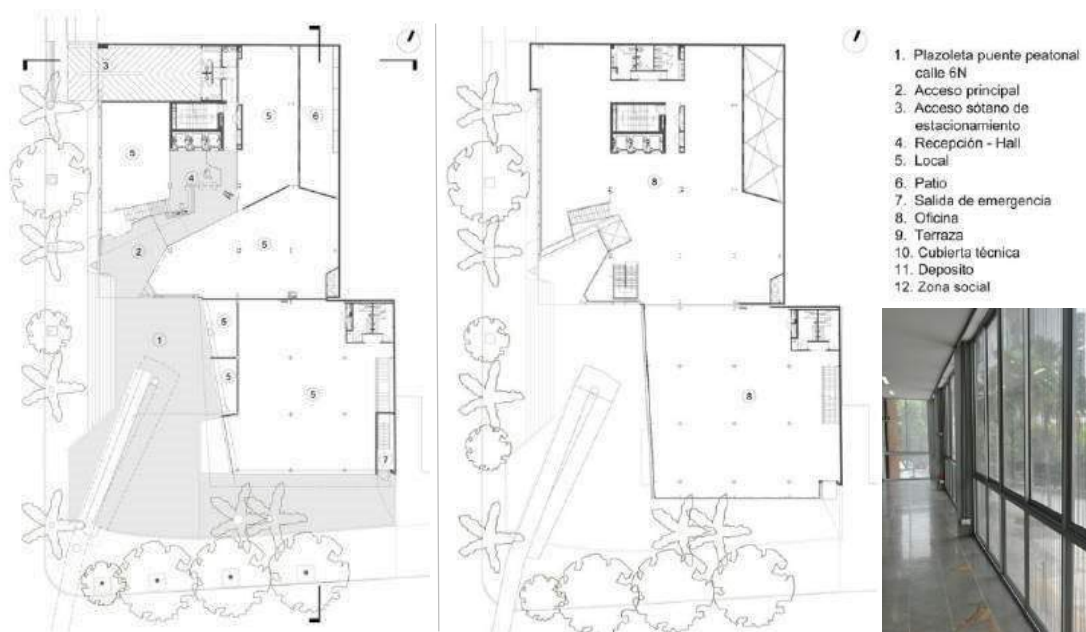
Planos del 1er y 2do nivel del Centro Empresarial Torre Centenario. Fuente: Archdaily
